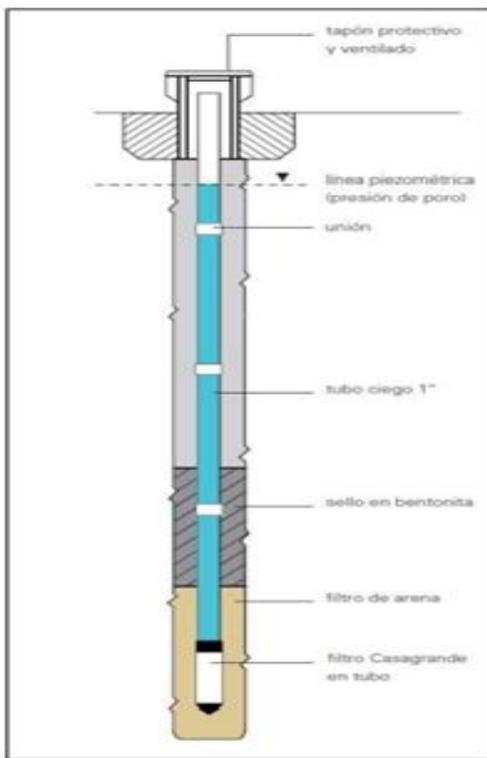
Esquema del piezómetro tipo Casagrande (Fuente: SISGEO, 2016)
